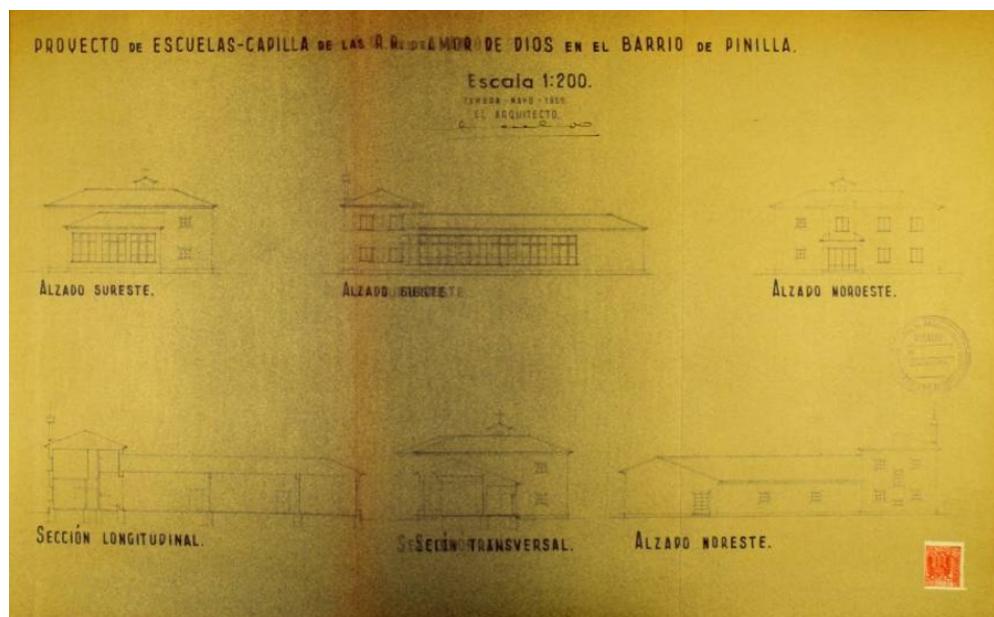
Plano de alzados y secciones. AHPZa. DPV. 32/24.
